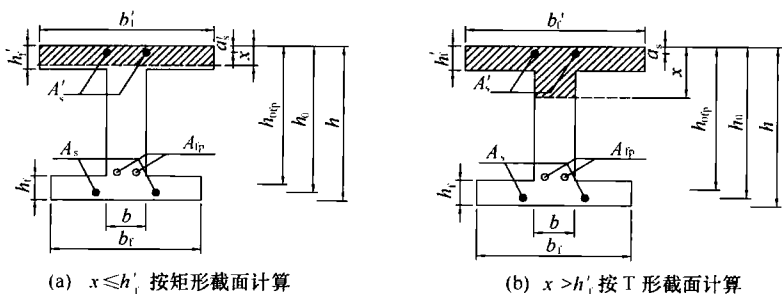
T形、I形截面预应力 FRP 钢筋混凝土受弯构件正截面承载力计算
